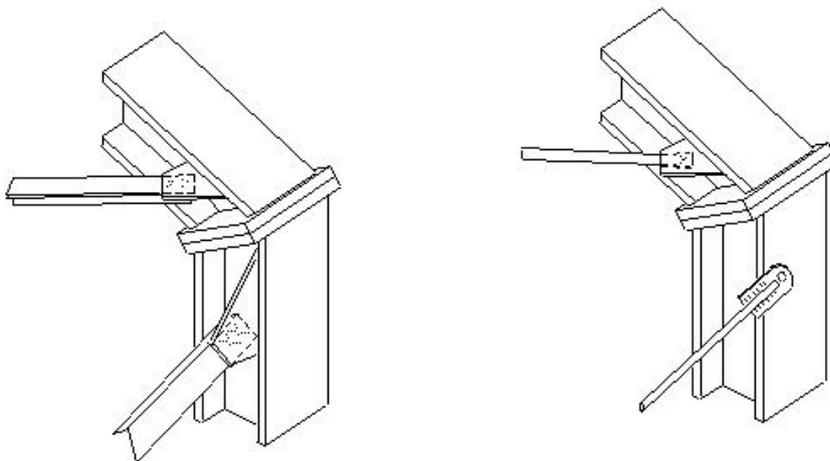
Konstruktionsdetails zum Anschluss von Verbänden
